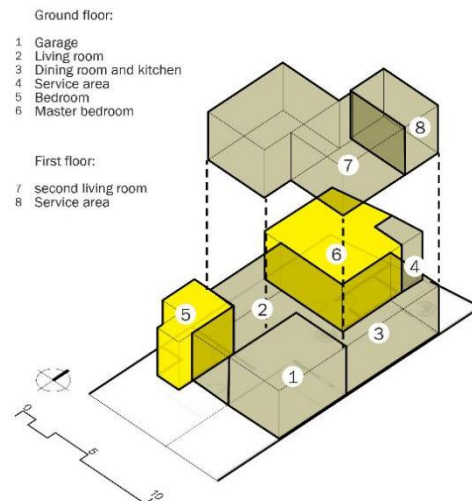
Prototipe – Rasio Luas Lantai & Massa dan Zona Bangunan
